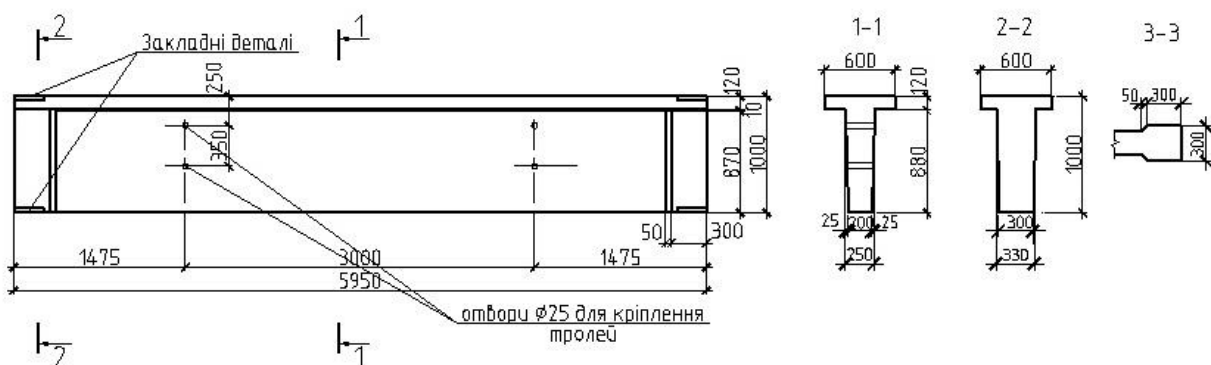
Опалубка підкранової балки прольотом 6 м
